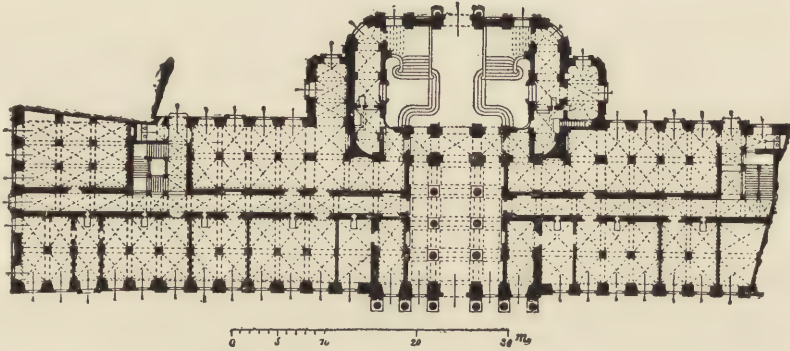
Landhaus, Grundriss des Erdgeschosses.
